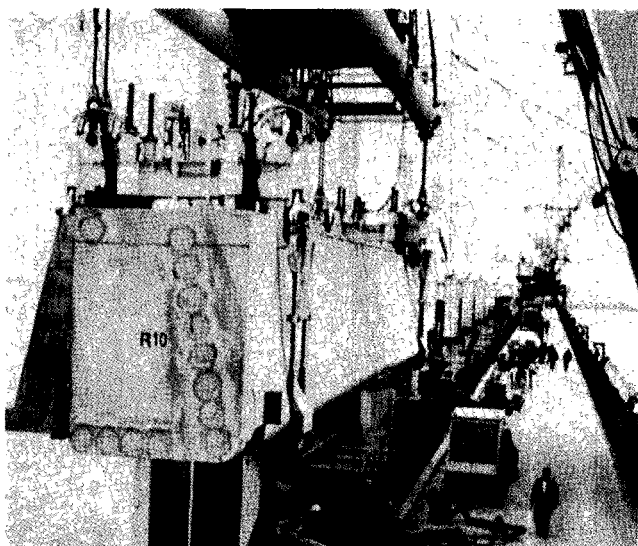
Het plaatsen van de bovenbalk (de laatste Roompot 10)
